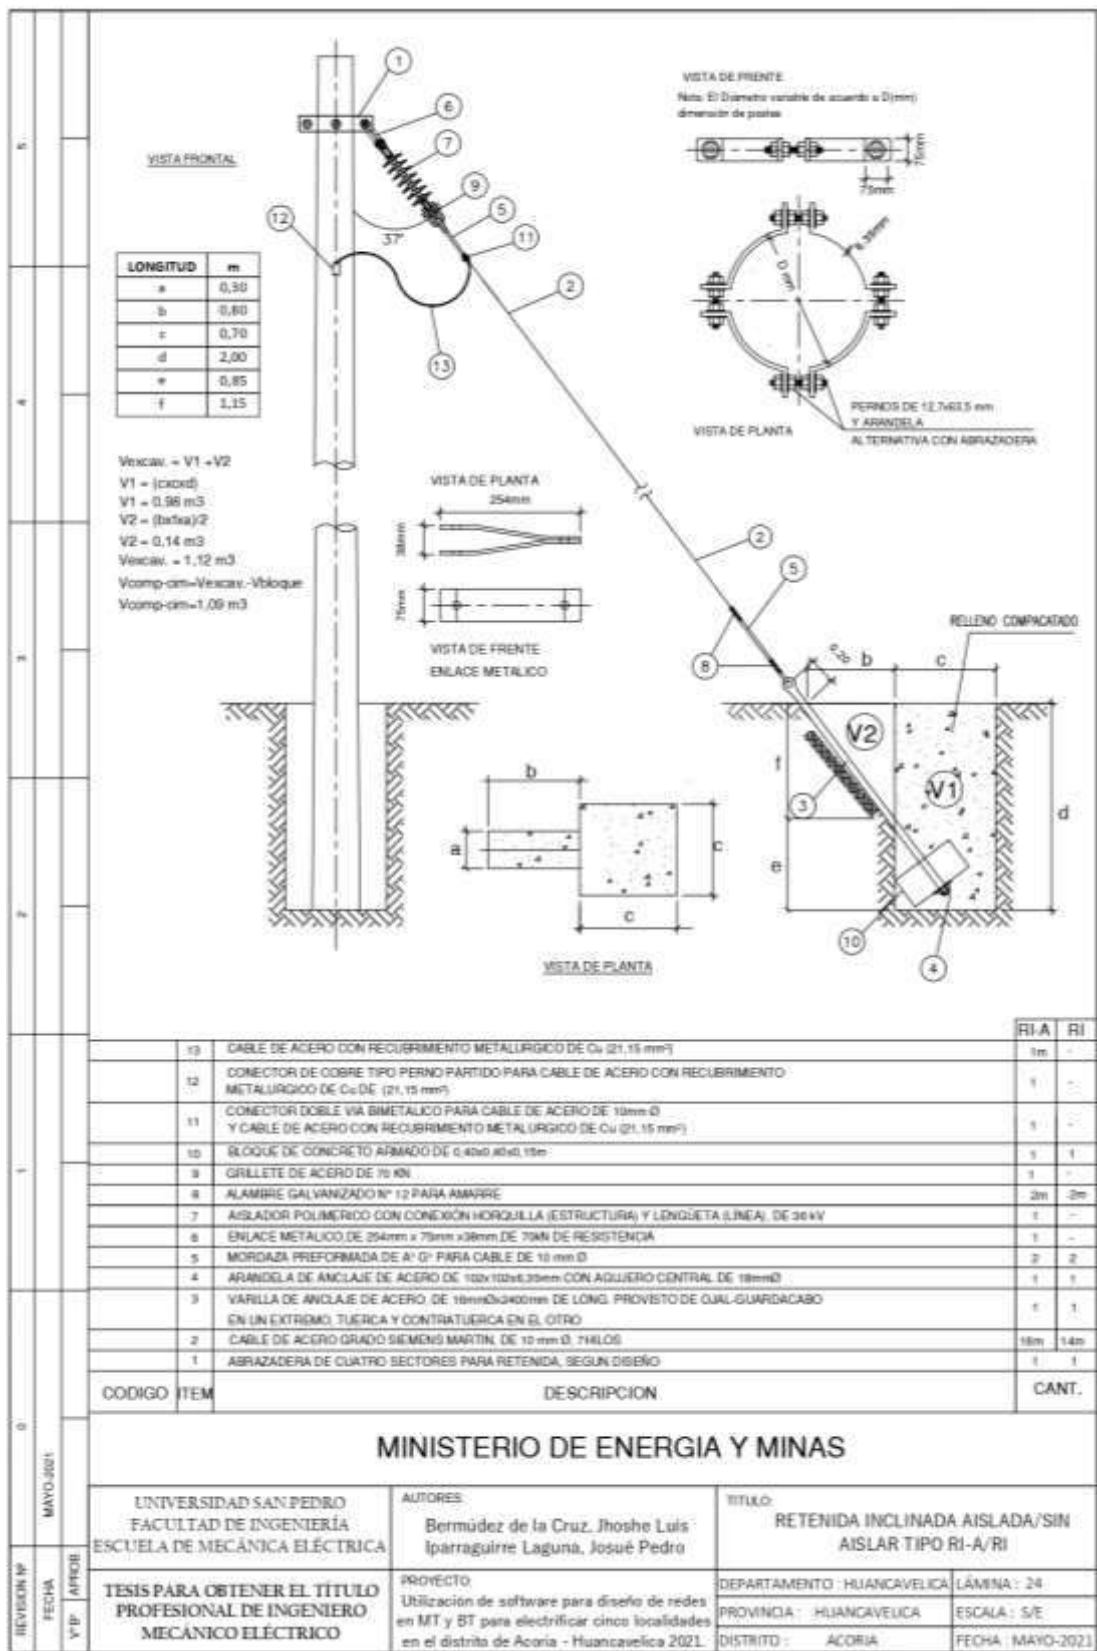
Lamina de detalle 24, retenida inclinada aislada/sin aislar tipo RI-A/RI
